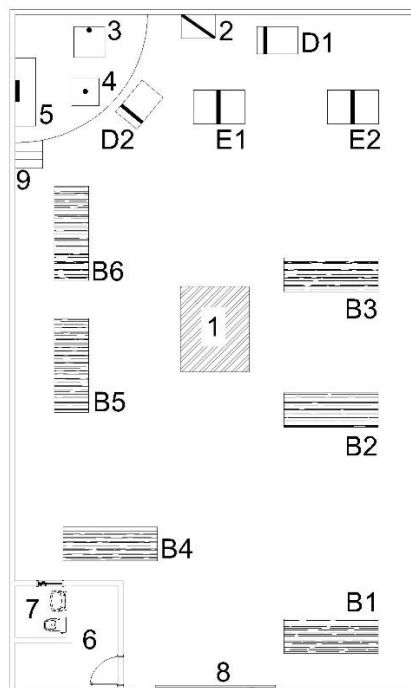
Planta baixa da fábrica de móveis. Fonte: O autor
